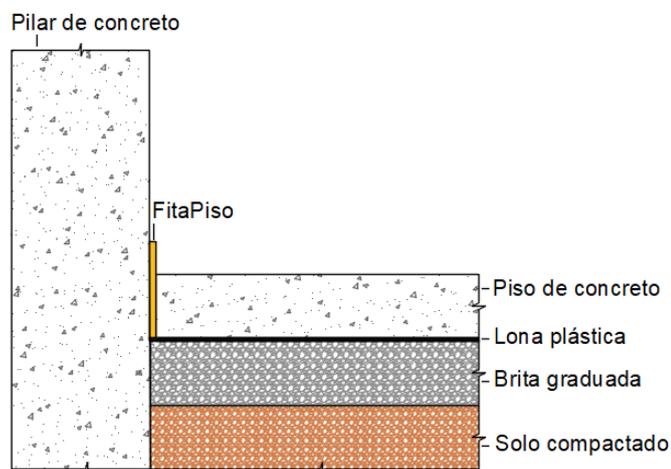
Posicionamento da FitaPiso para dessolidarização entre pilar e piso de concreto
